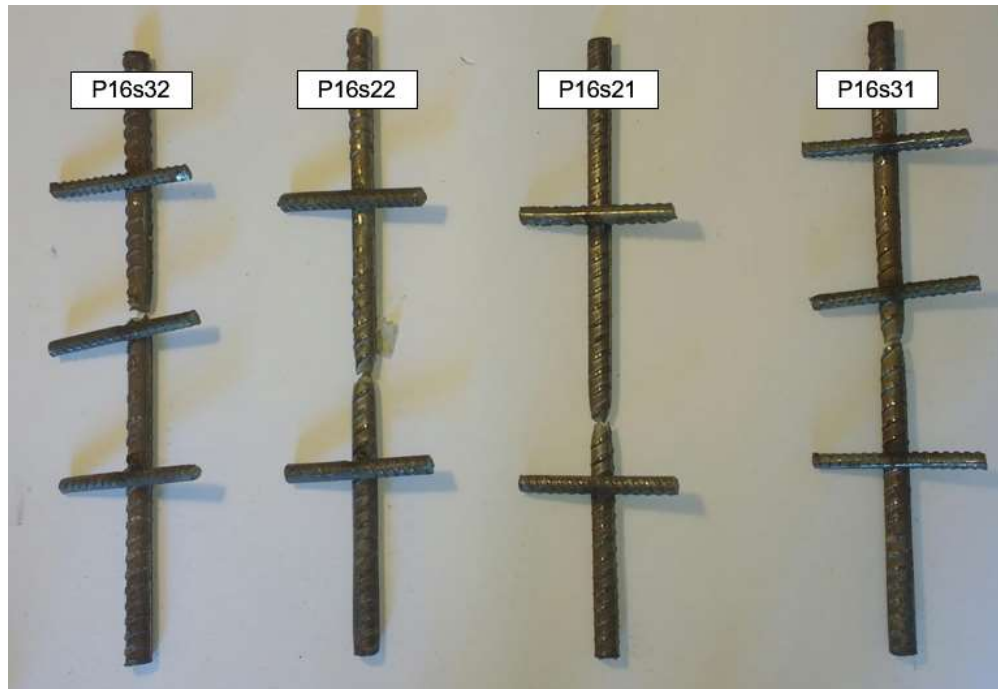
Zona de falla de probetas de 16 mm soldadas.
